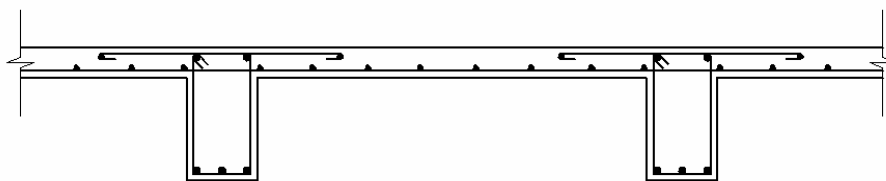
Laje nervurada, conforme GUERRIN (2002).
